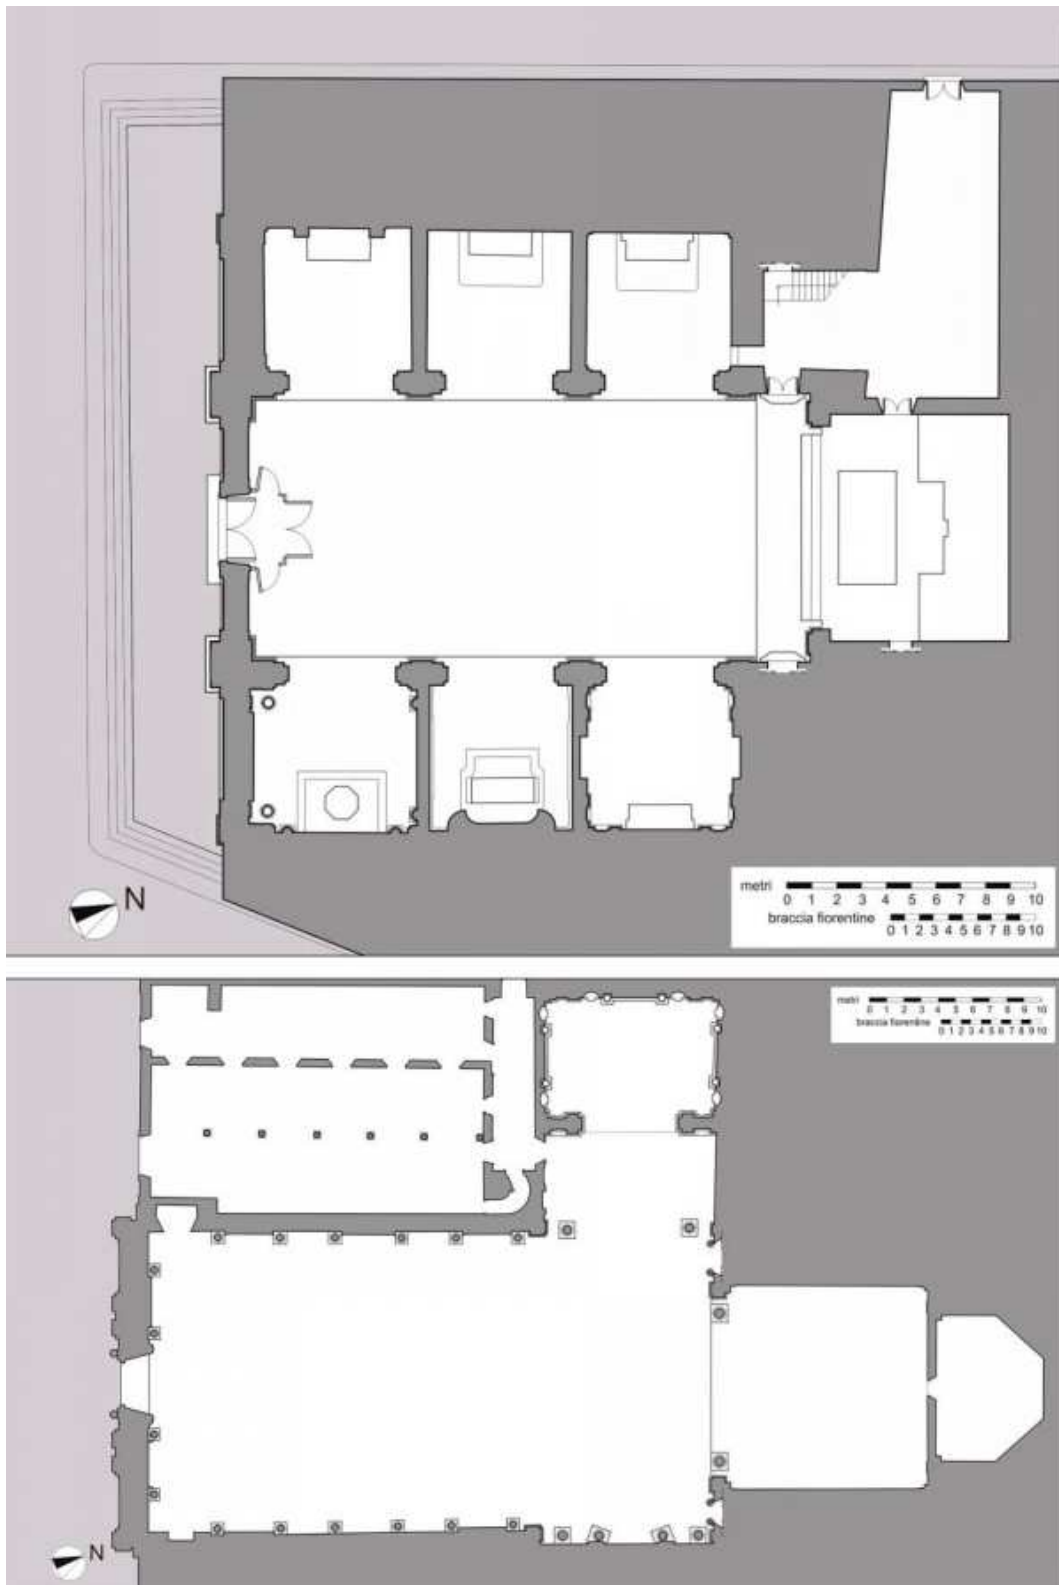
A- Pianta della Chiesa di San Giuseppe. B- Pianta della Chiesa di San Marco.
